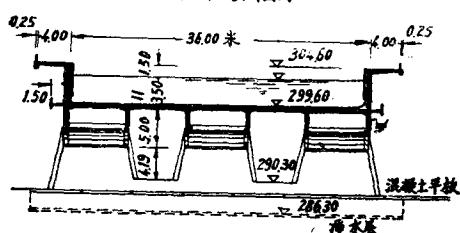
Dyckhoff & Widmann 设计的预应力钢筋混凝土方案的纵横断面图
